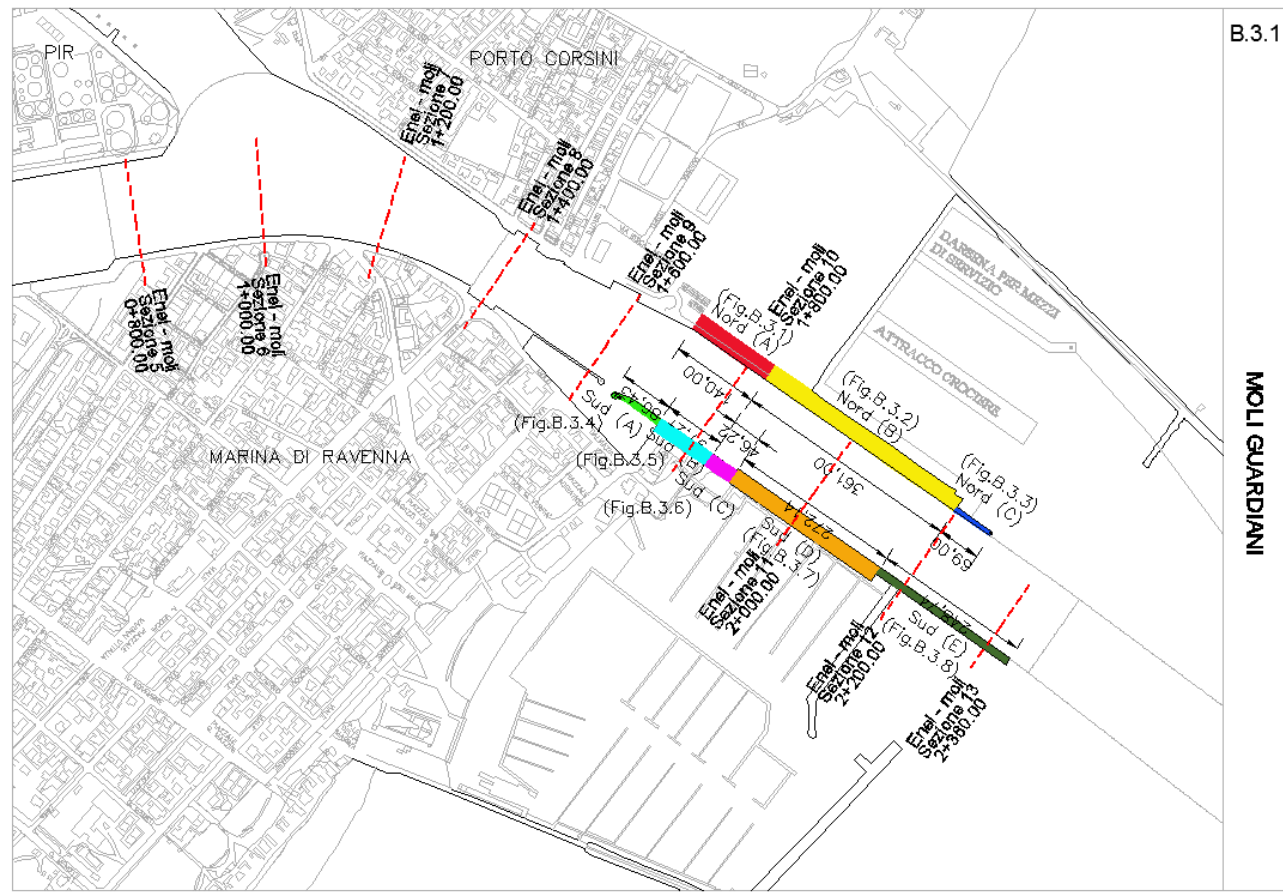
Stralcio planimetrico del Canale Candiano con l'indicazione delle sezioni e delle banchine considerate nel tratto ENEL – MOLI (1 di 2)
